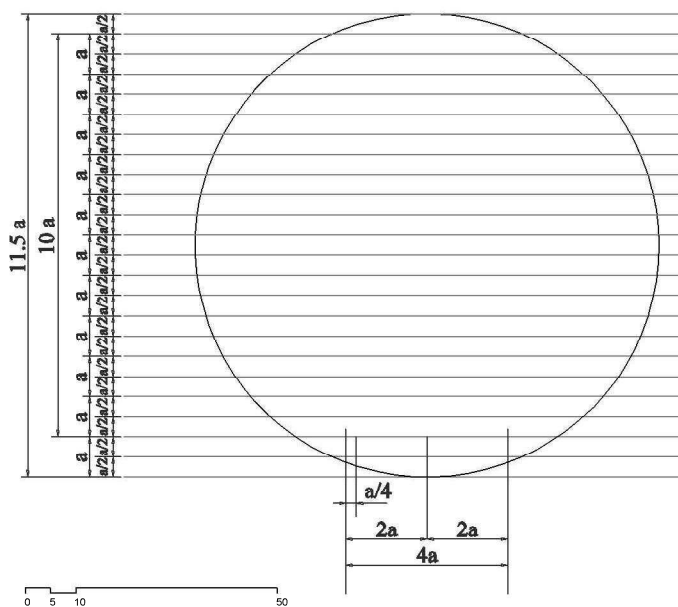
Boceto sobre el alzado original para realizar la planimetría. Elaboración propia.
